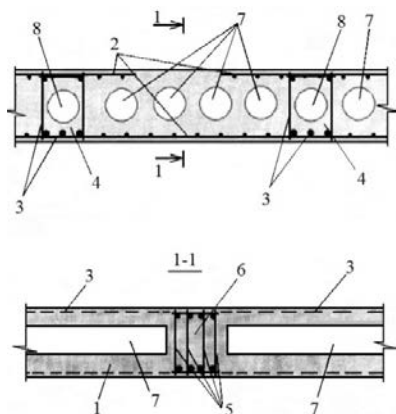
Конструкция облегченного железобетонного перекрытия с цилиндрической формой вкладыша : 1 – балочная плита; 2 – арматура балочной плиты; 3 – арматурный каркас второстепенной балки; 4 – второстепенная балка; 5 – арматурный каркас главной балки; 6 – главная балка; 7, 8 – вкладыши
